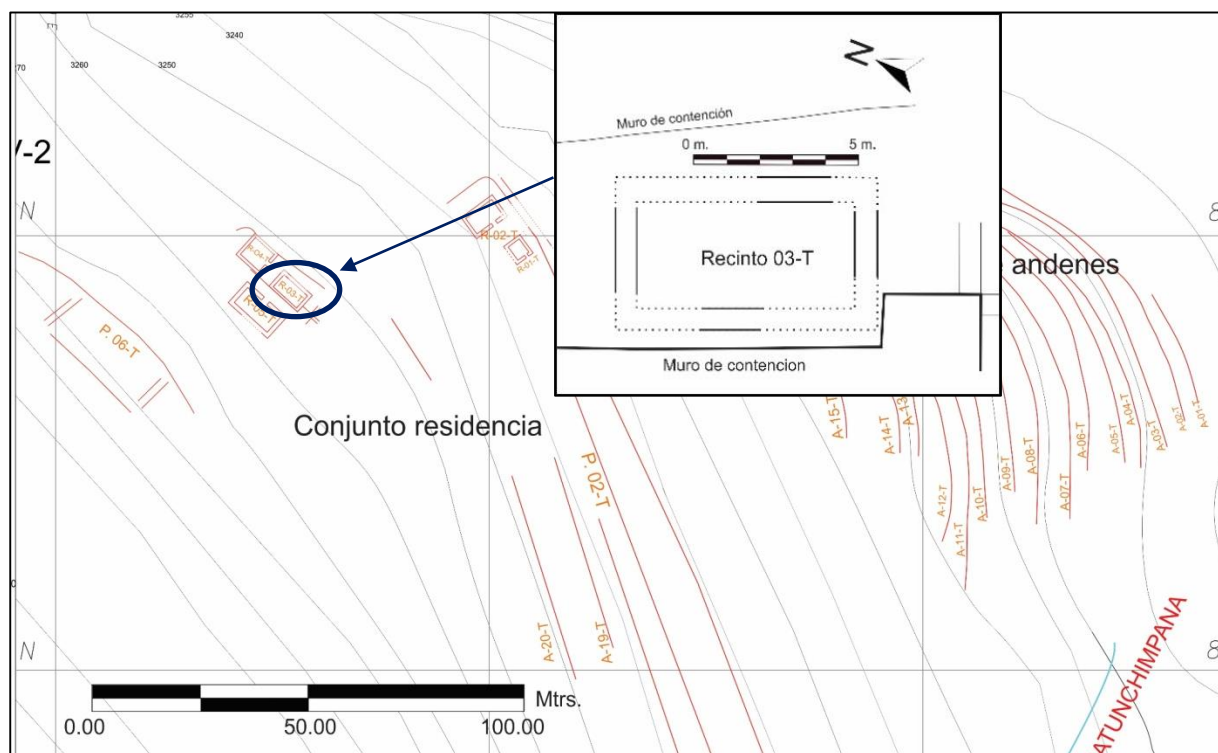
Plano de planta del recinto 3-T y asociados a arquitectura de la plataforma sobre la que se ubica el recinto. Fuente: Elaboración propia.
